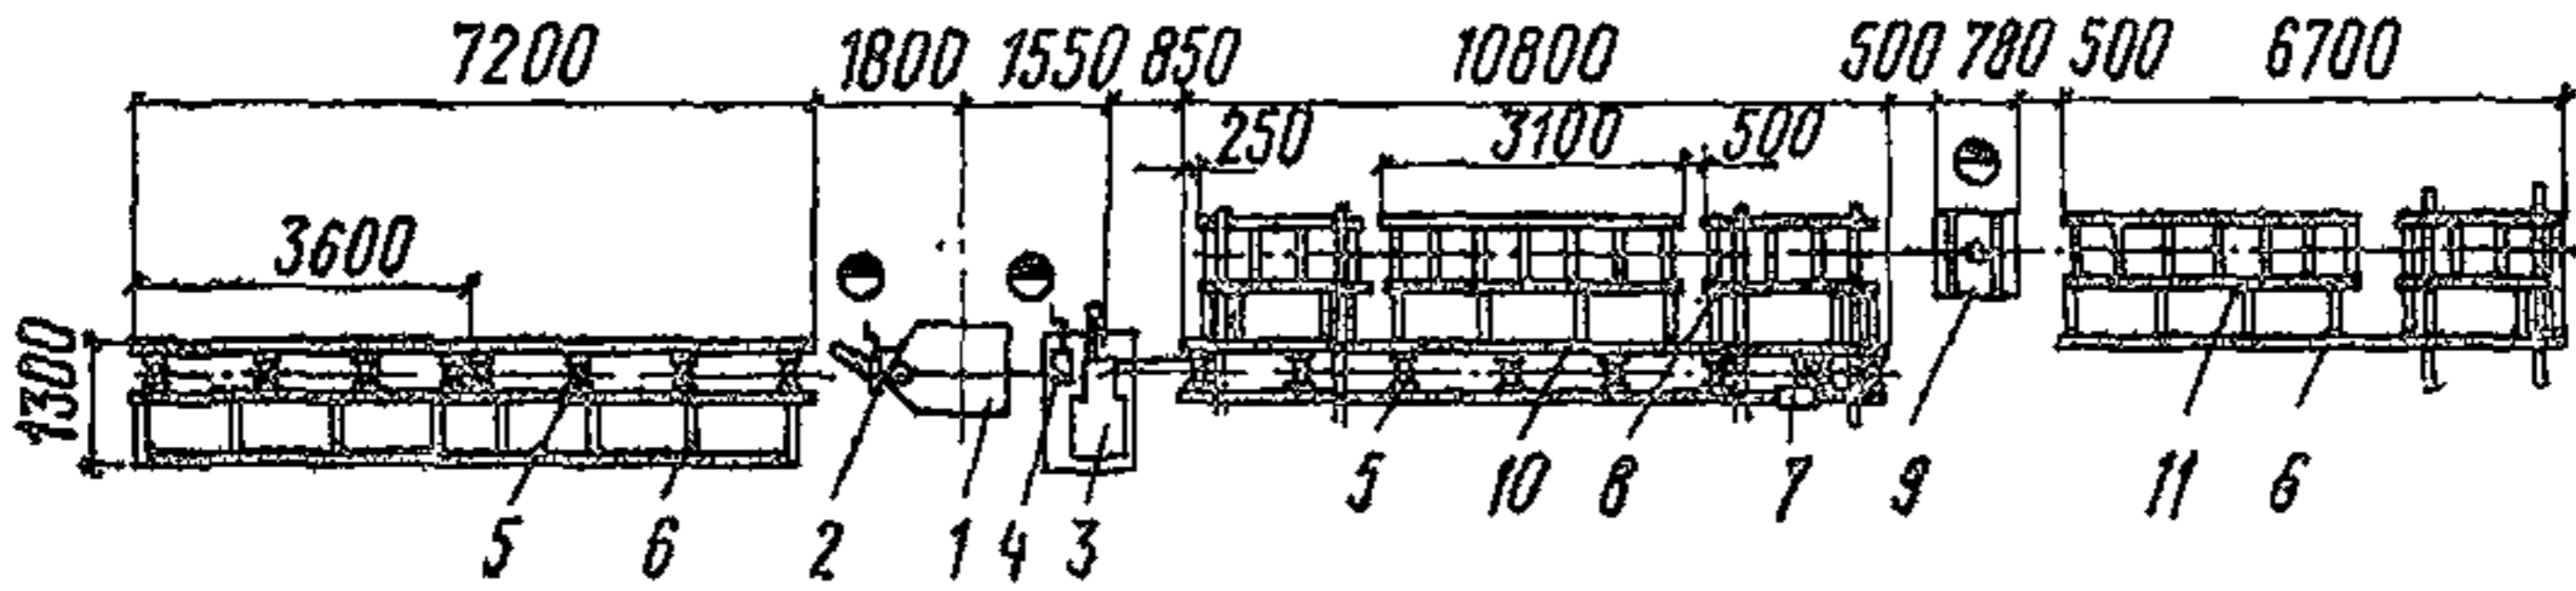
Схема организации рабочих мест линии безотходной стыковой сварки, резки и гибки арматурных стержней
